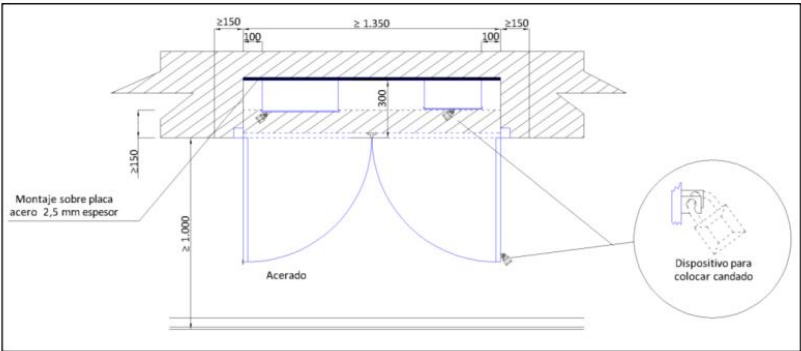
Instalación CGP y CS montaje horizontal. Planta.
